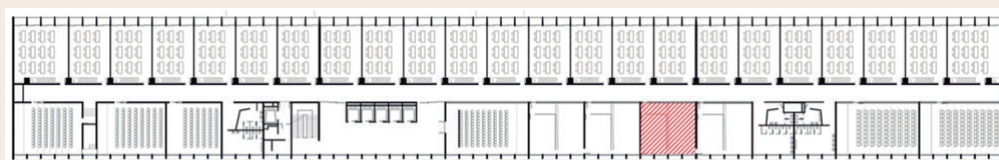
Planta Baixa do pavimento tipo do bloco A do Edifício JMM. Sala analisada destacada em vermelho.
